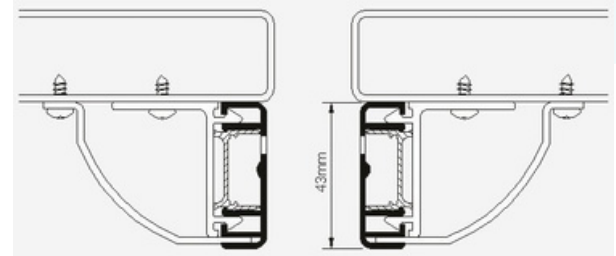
Profilo da 43 mm in apertura centrale, con 2 supporti a "L" e protezioni
